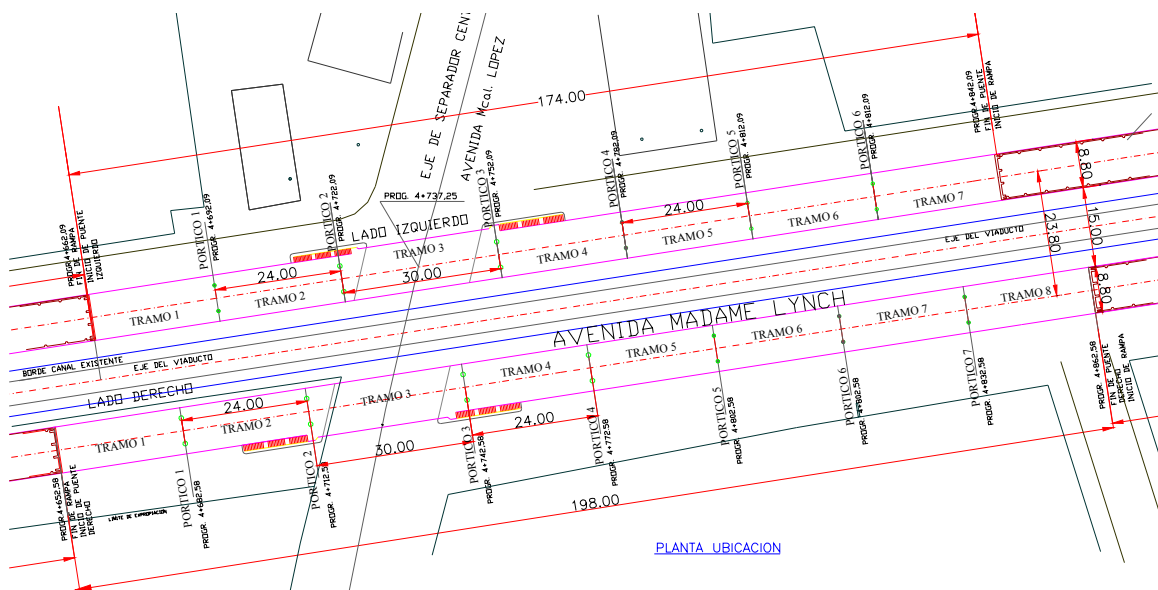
PLANTA DE VIADUCTO PREFABRICADO ADAPTADO SOBRE MARISCAL LÓPEZ
